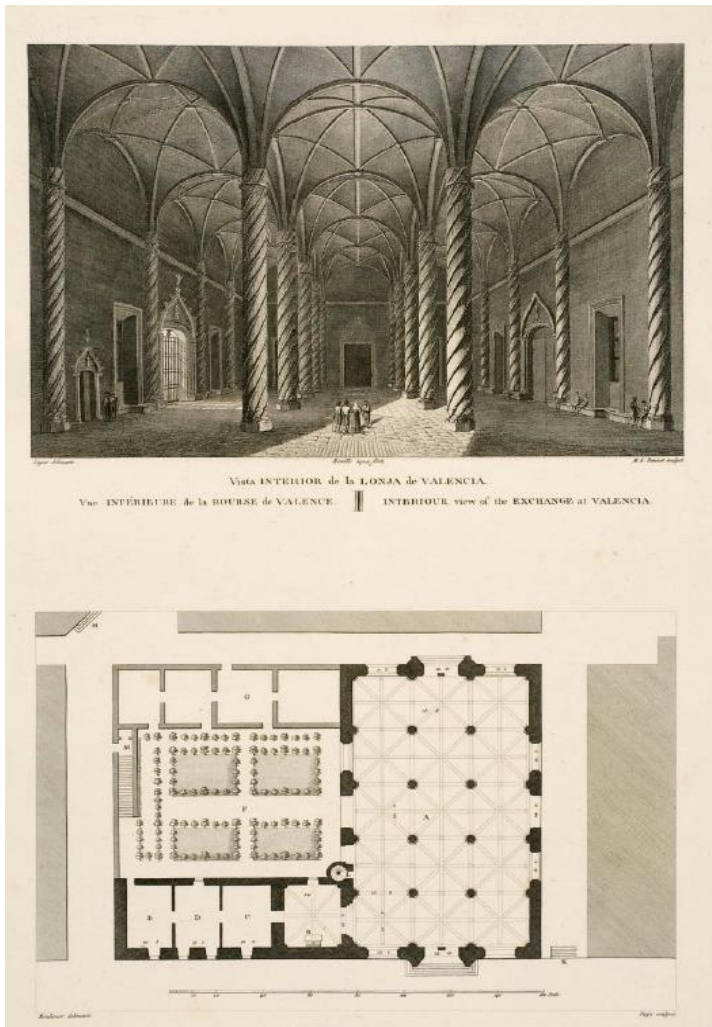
Alzado interior de la Lonja y planta. Alexandre Laborde, 1811.
